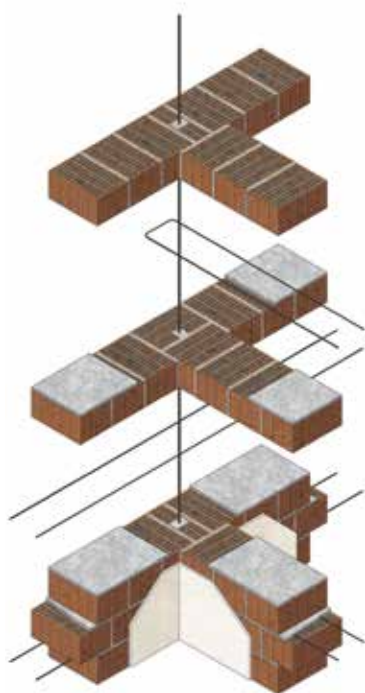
Incrocio di muratura armata in blocchi in laterizio a isolamento diffuso / *Reinforced masonry crossing in insulating blocks
